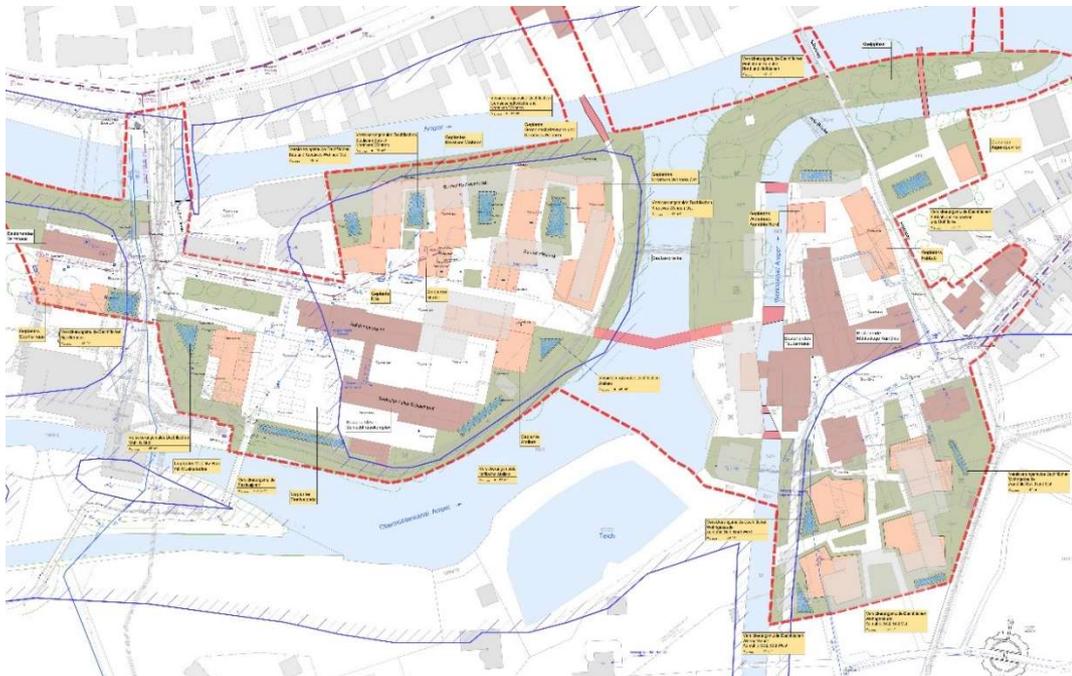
Entwässerungskonzept, Lageplan (Ausschnitt)
